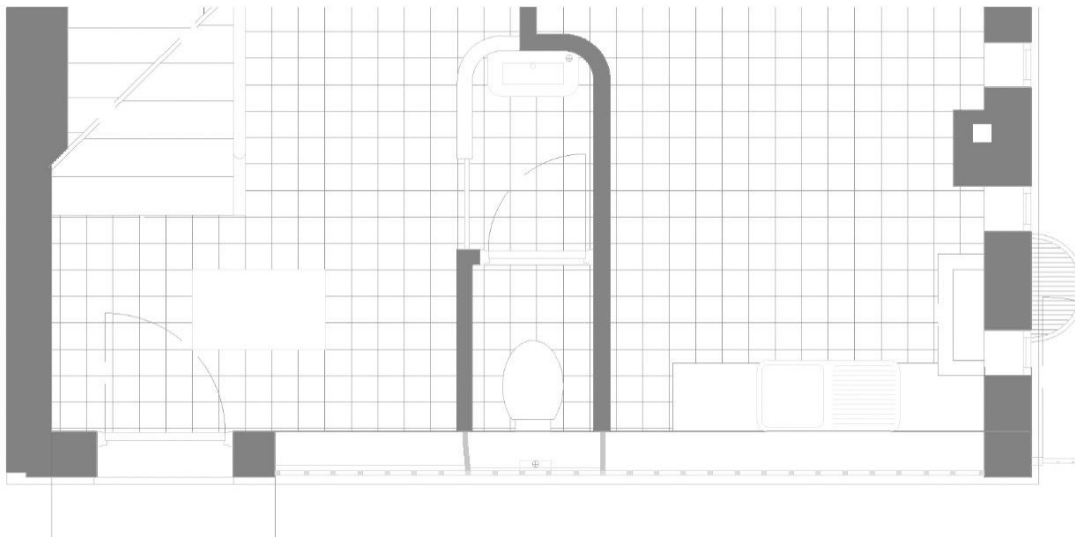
Fragmento de la planta baja de la casa Guiette a escala 1:25 para mostrar como la fenêtre en longueur recorre casi por completo los 6 metros de fachada de la vivienda
